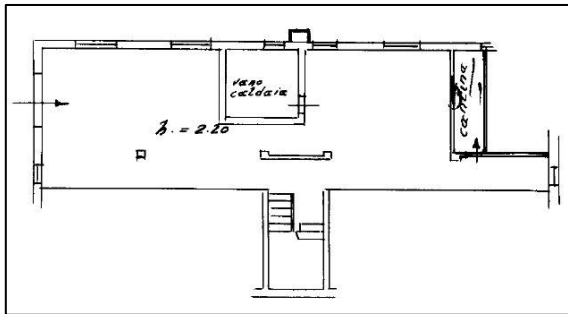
Planimetria catastale del 31.12.1964 - P. Interrato
